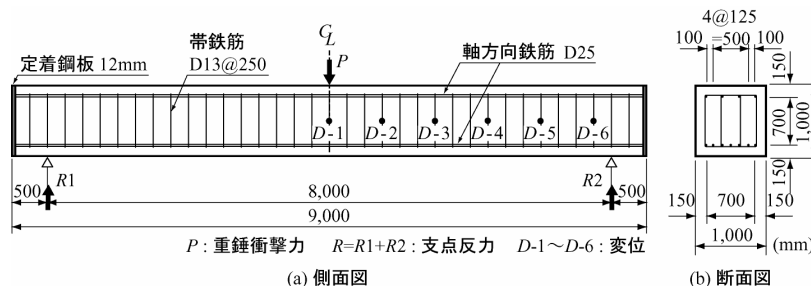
大型 RC 梁試験体の形状寸法および配筋状況
